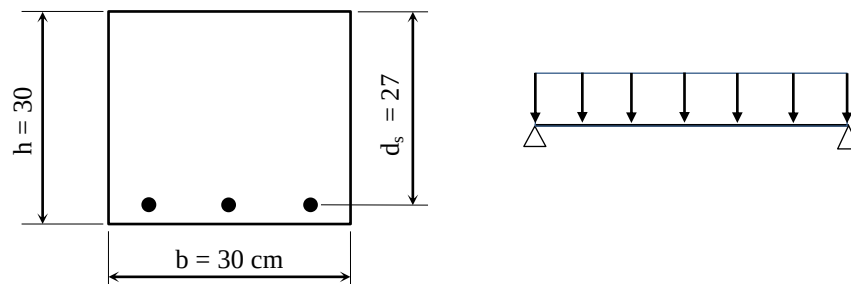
Dimensões (cm) da seção transversal da laje.
